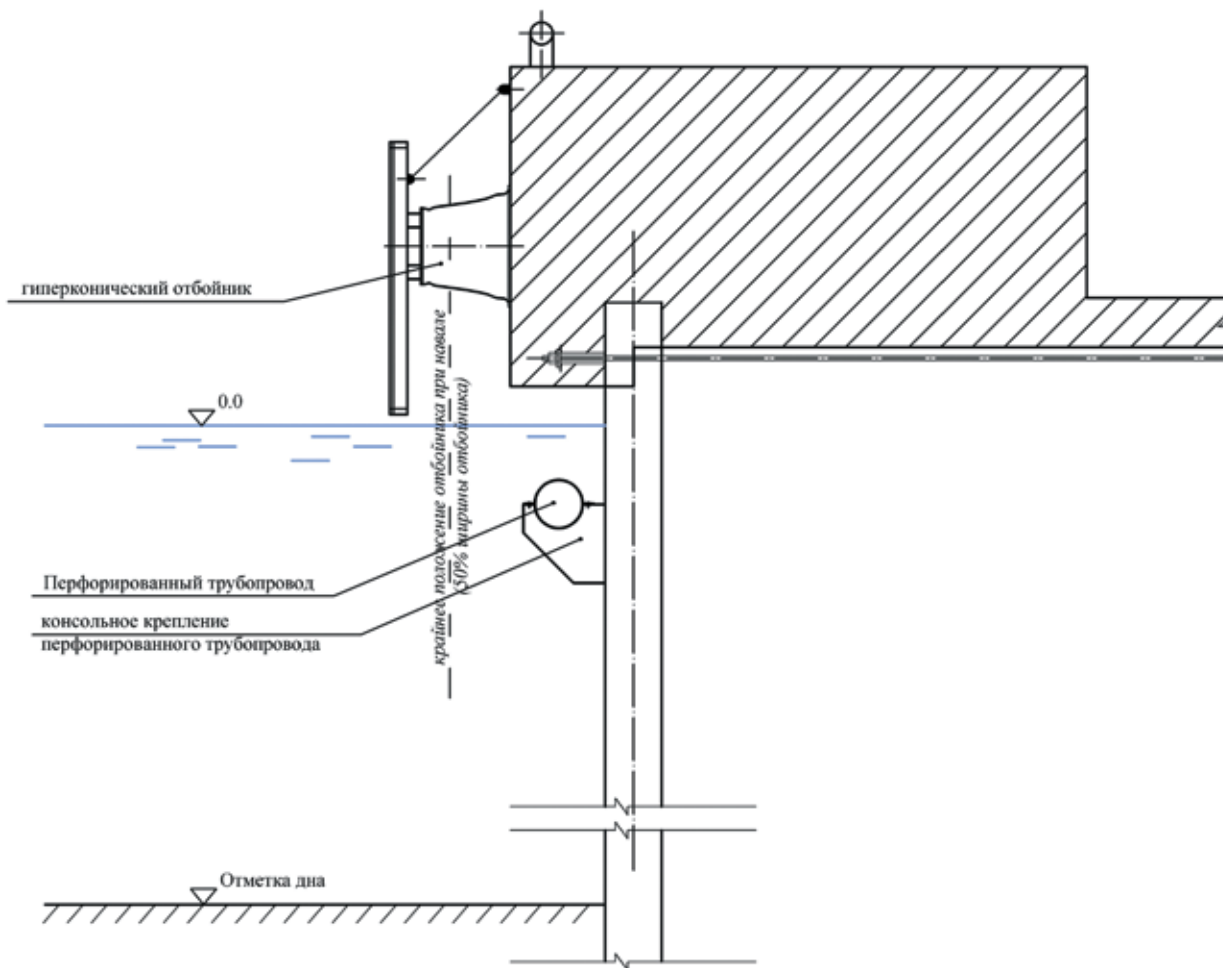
Схема размещения перфорированного трубопровода на причальной стенке
